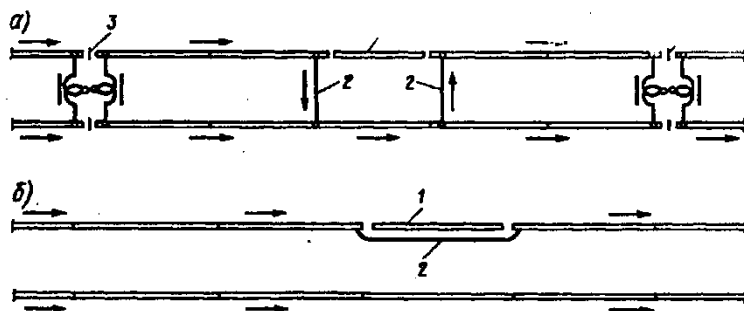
Схемы укладки обходных перемычек при смене рельса:
